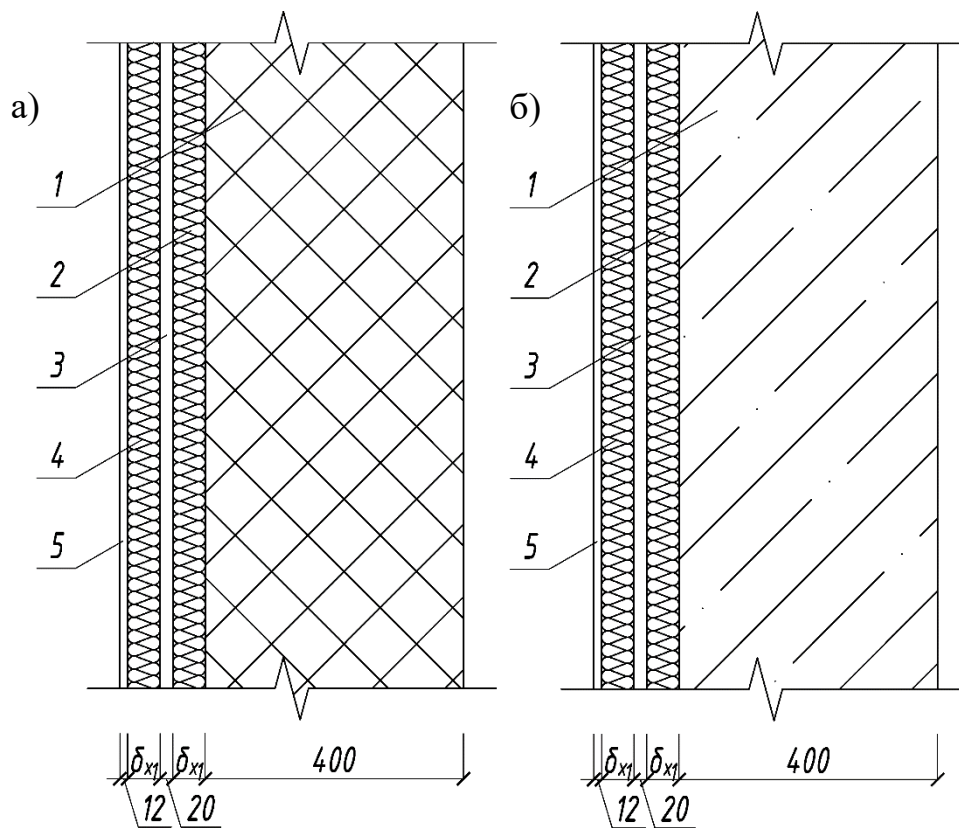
Схема розрізу о.к.: 1 – а)газобетон, б)залізобетонна колонна; 2 – перший шар утеплювача; 3 – повітряний прошарок; 4 – другий шар утеплювача; 5 -фіброцементна плита на каркасі.
